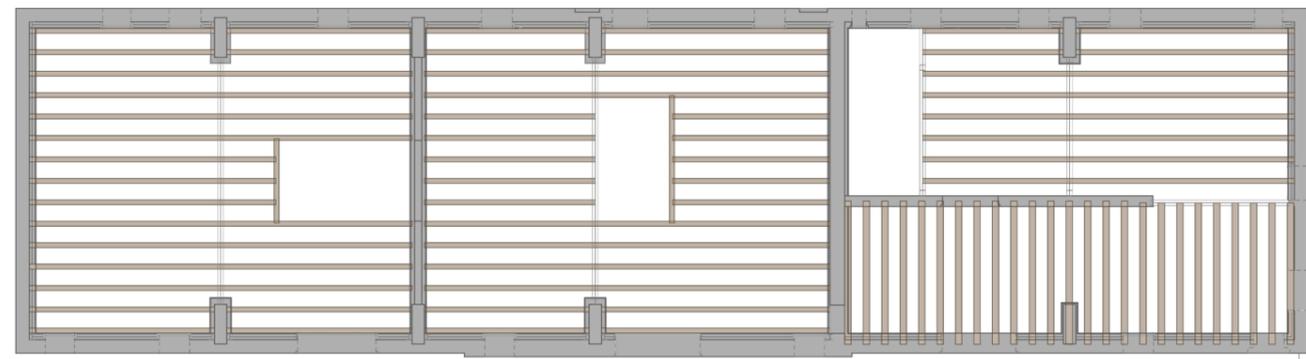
Pianta del piano terra, rilievo costruttivo, scala 1:200
